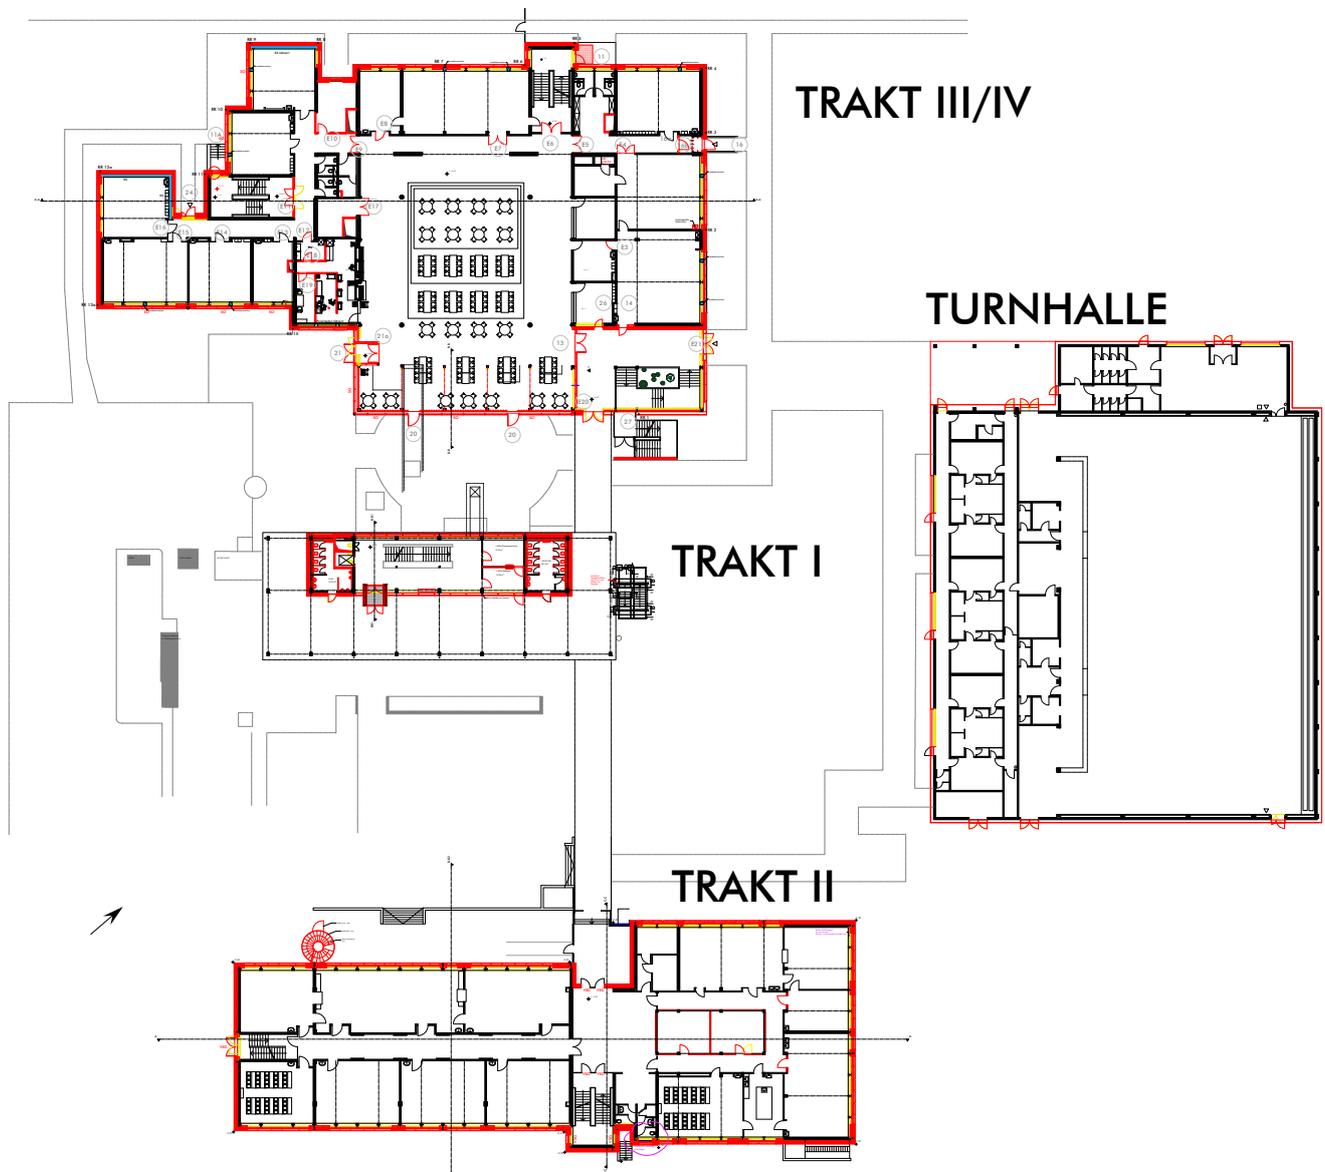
Grundriss Übersicht Gymnasium Baesweiler
